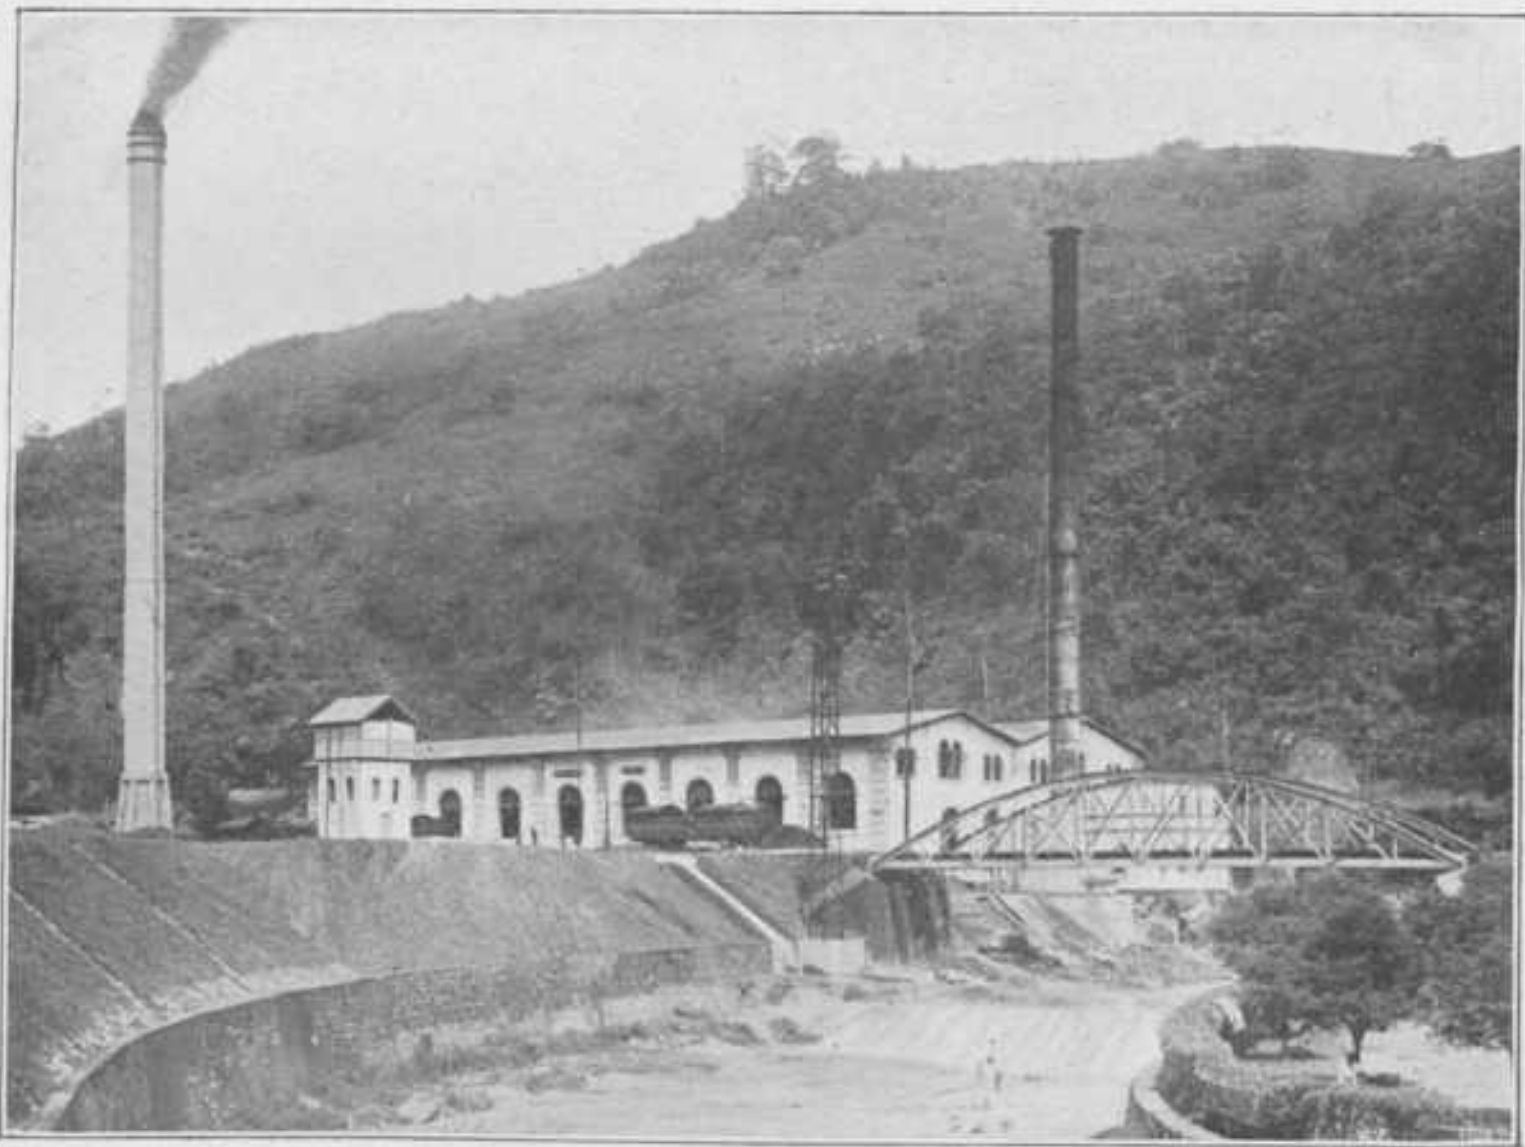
De elektrische centrale met den schoorsteen van gewapend beton.
